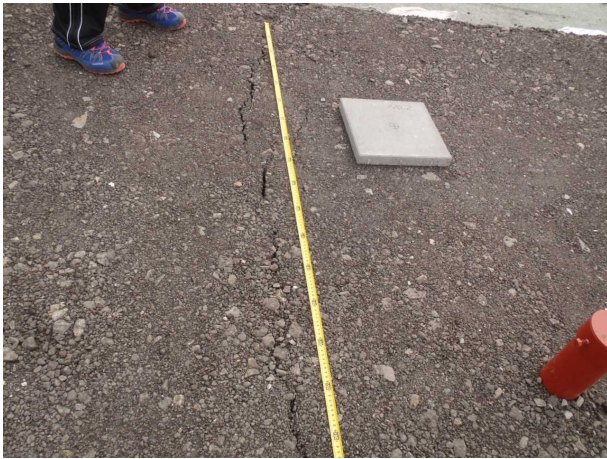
盛土天端のひび割れ発生状況の例 (札幌施工区)
